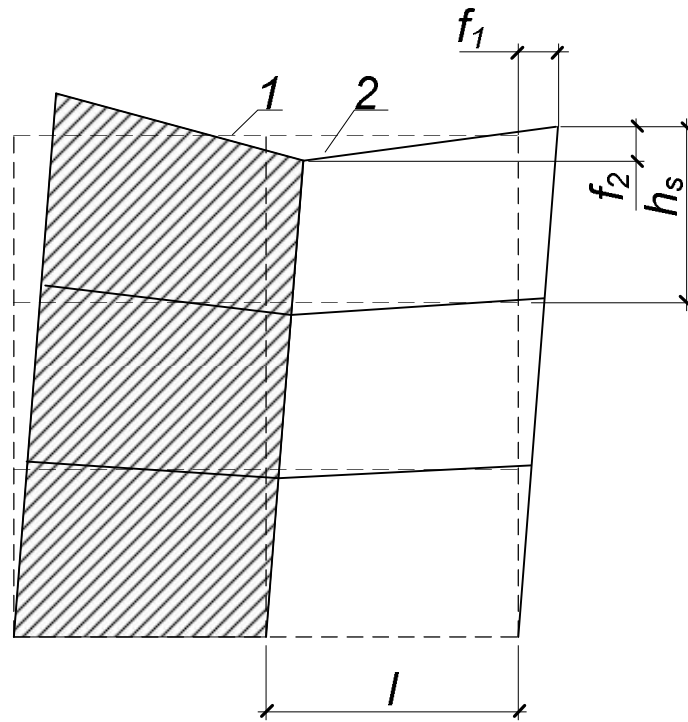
Схема перекосу поверхових комірок (2), що примикають до діафрагм жорсткості (1) у будівлях зі зв’язевим каркасом (пунктиром показана схема каркасу до прикладення навантаження)
